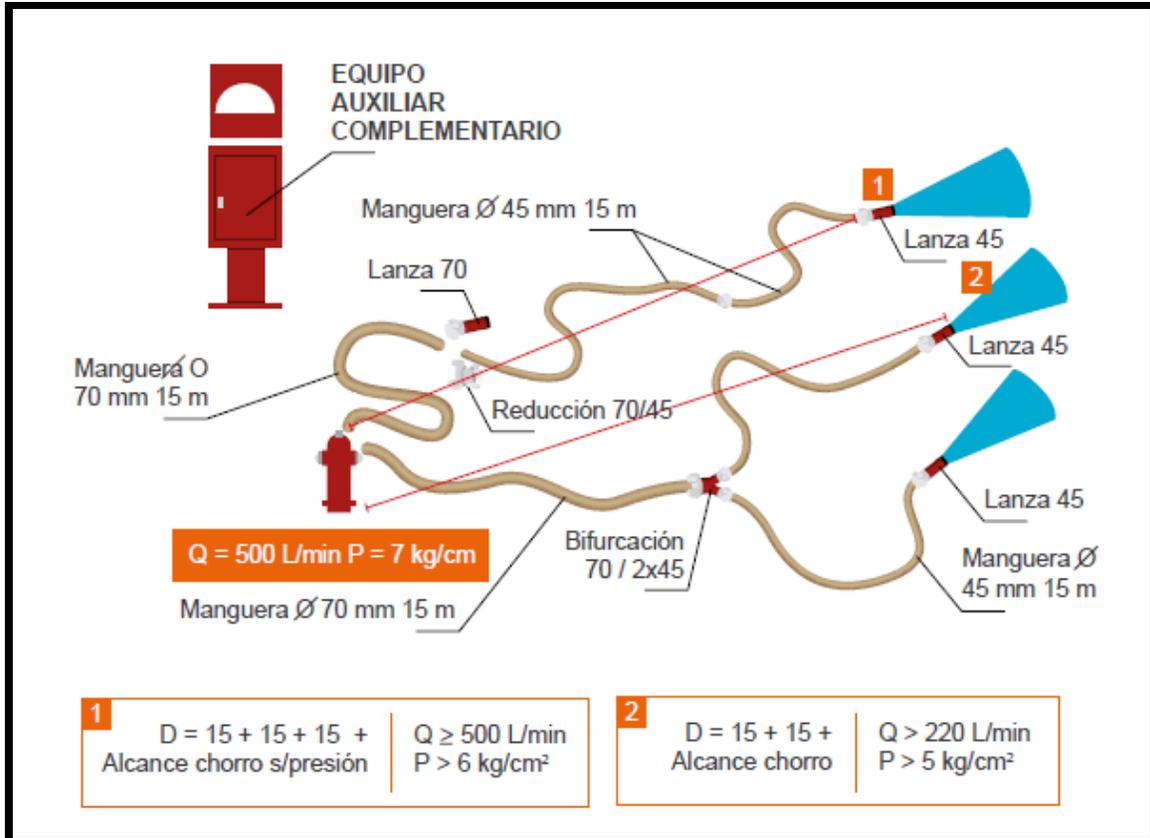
Características del sistema de hidrantes del proyecto de planta de reciclado.
